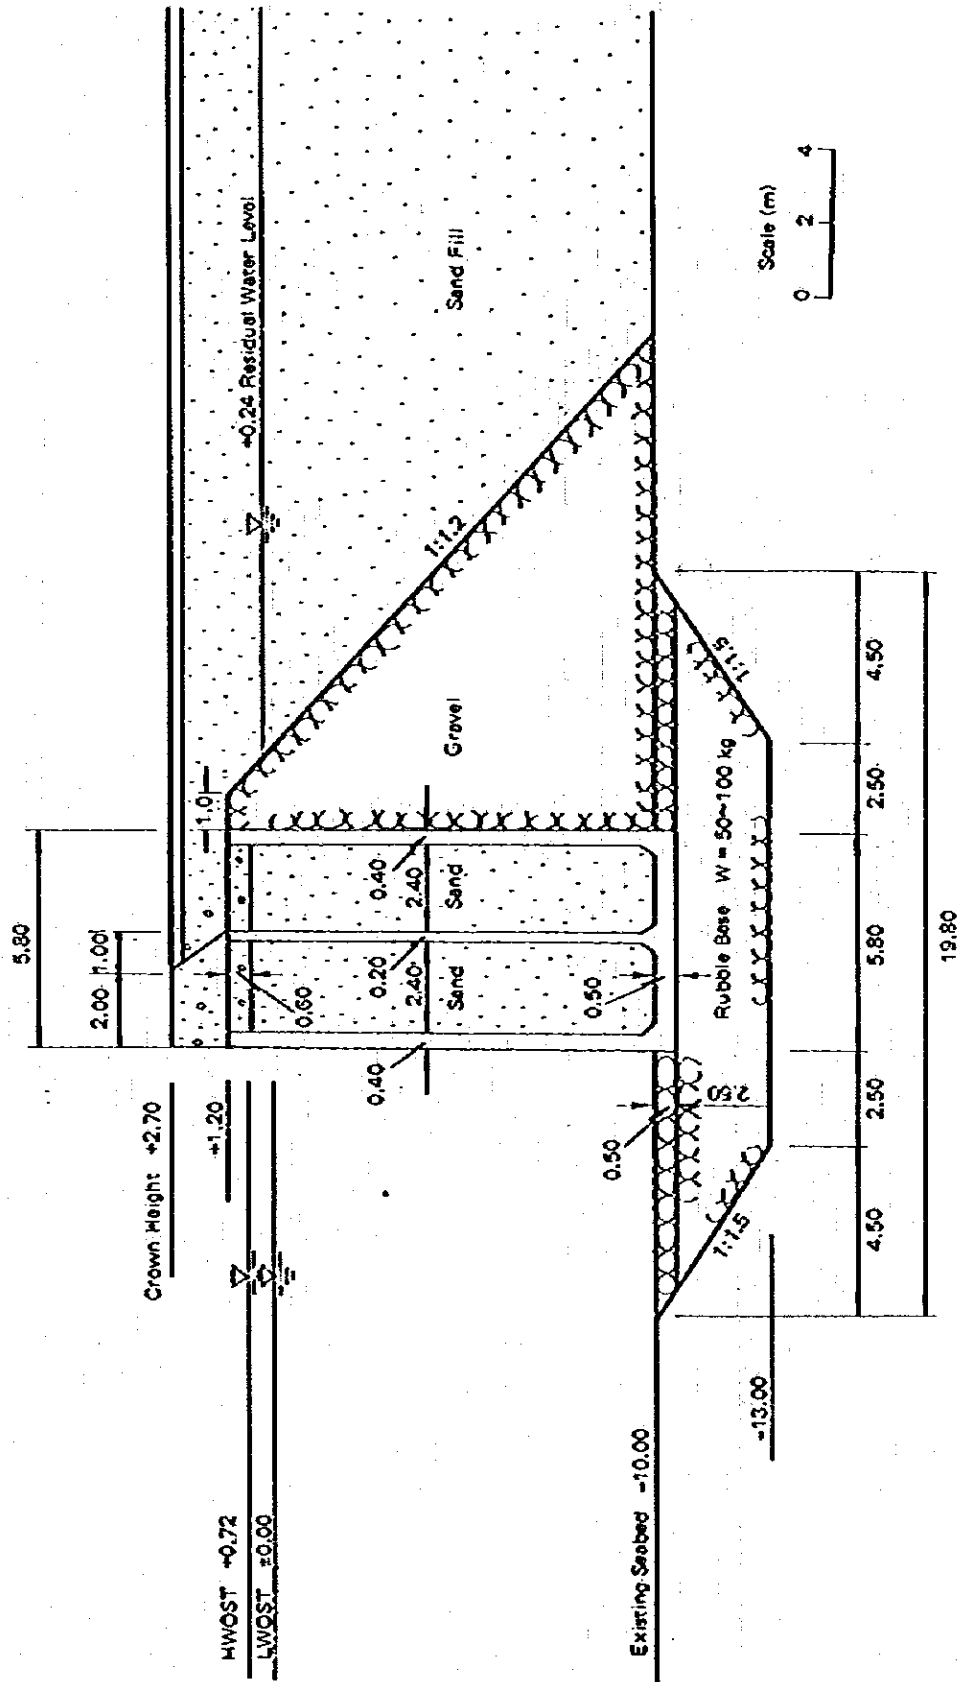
(b) 重力式ケーソン型橋脚平面図 (一10m)
